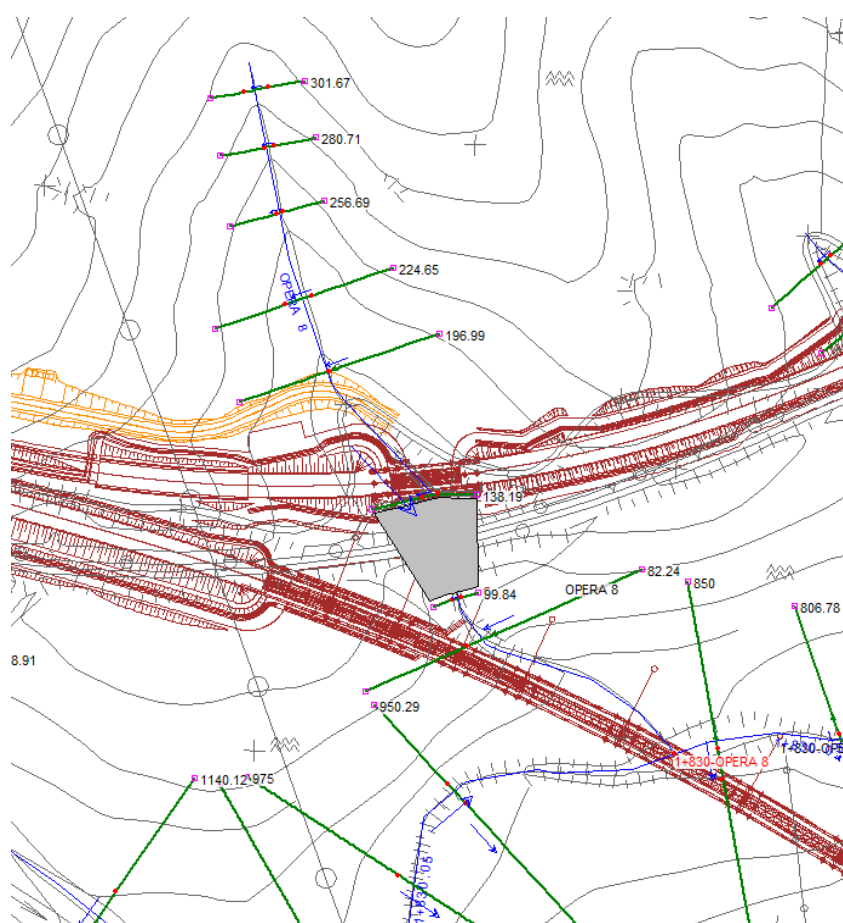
Planimetria Hec ras – sovrapposizione SDF – linea di progetto
